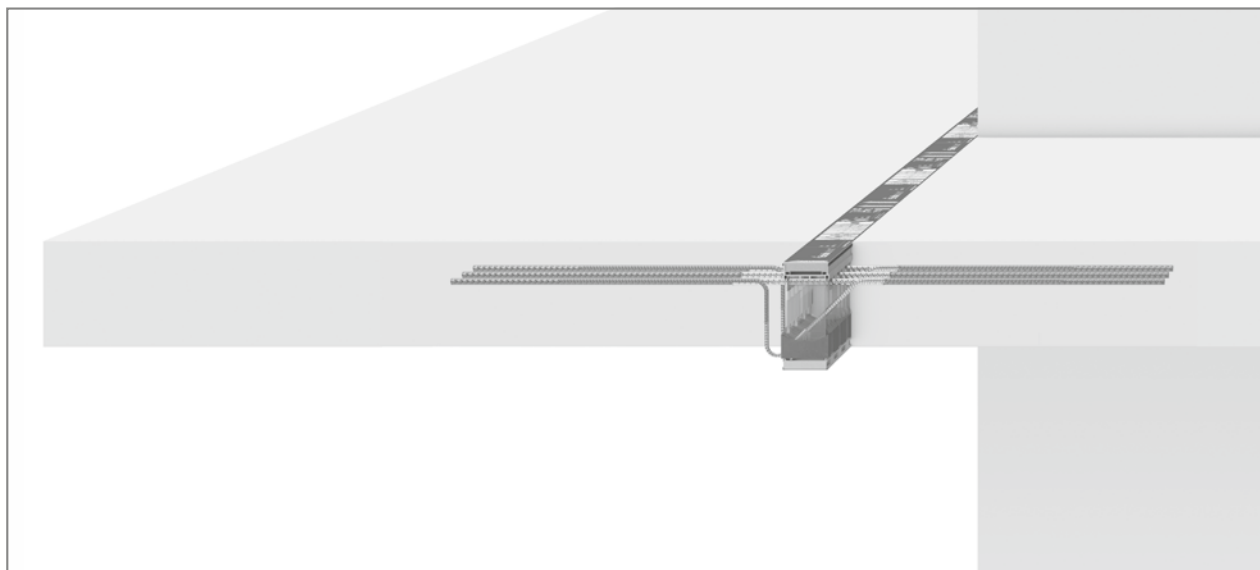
Schöck Isokorb® T tipo KL: collegamento balcone con supporto indiretto
